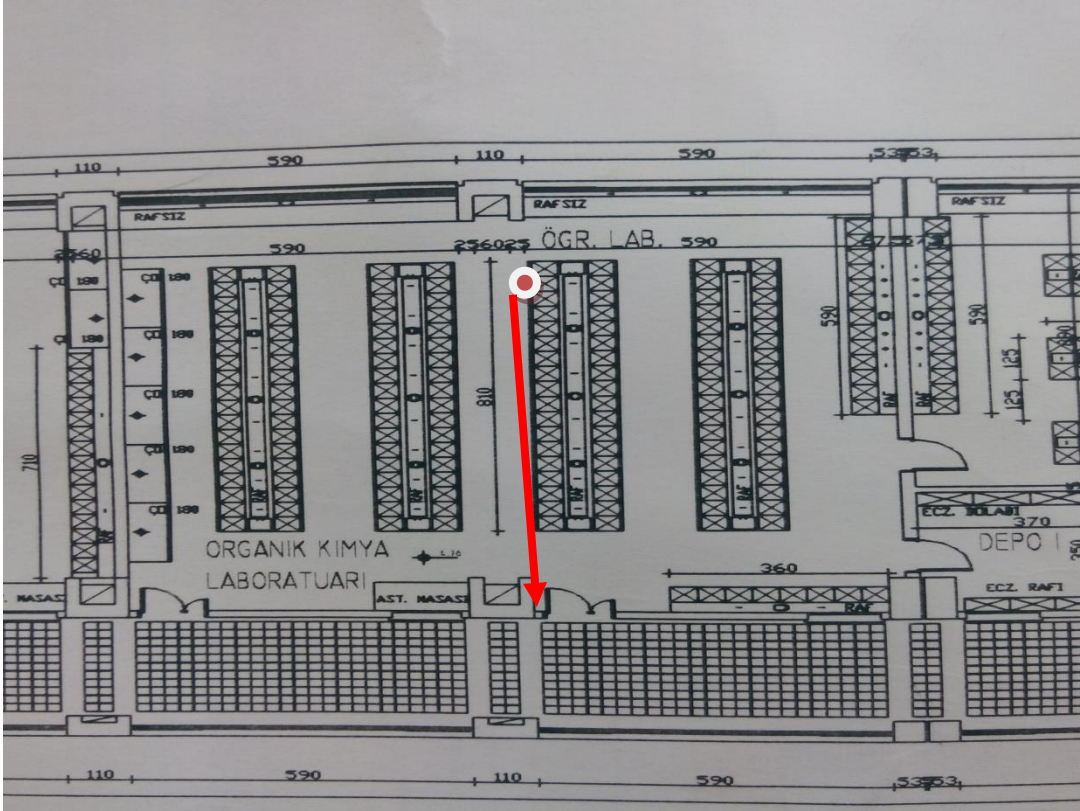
Organik kimya Lab. banko düzeni,kapı ve pencerelerin planı
